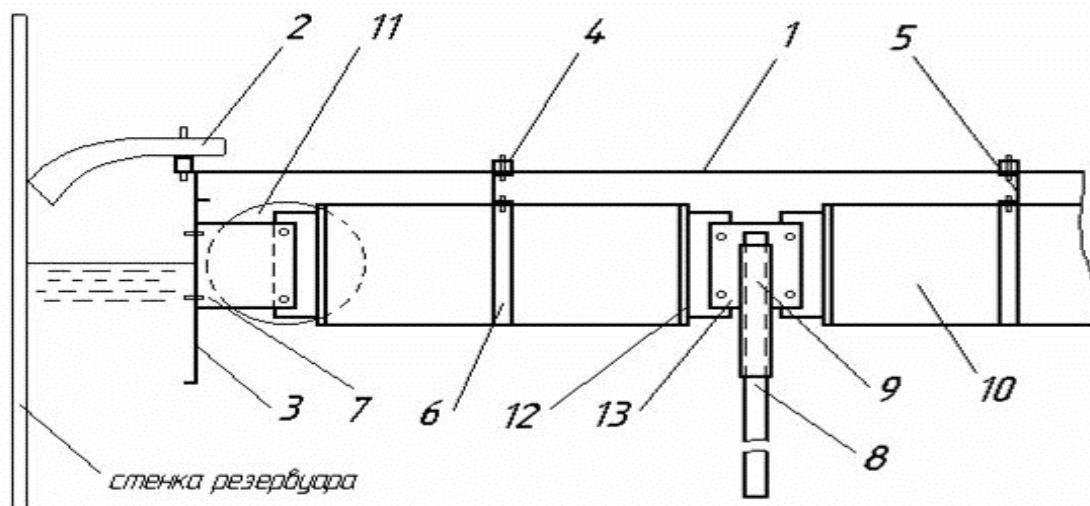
Разрез понтона поплавкового типа из алюминиевых сплавов:
